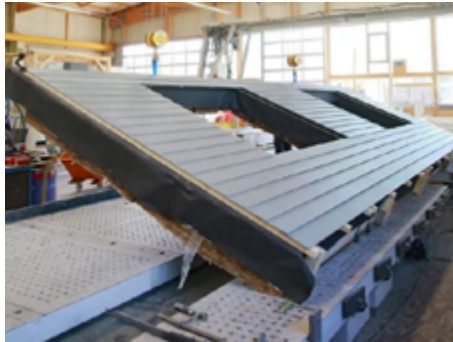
Fachada industrializada en taller. Fuente: Reto Kommerling (2023).
